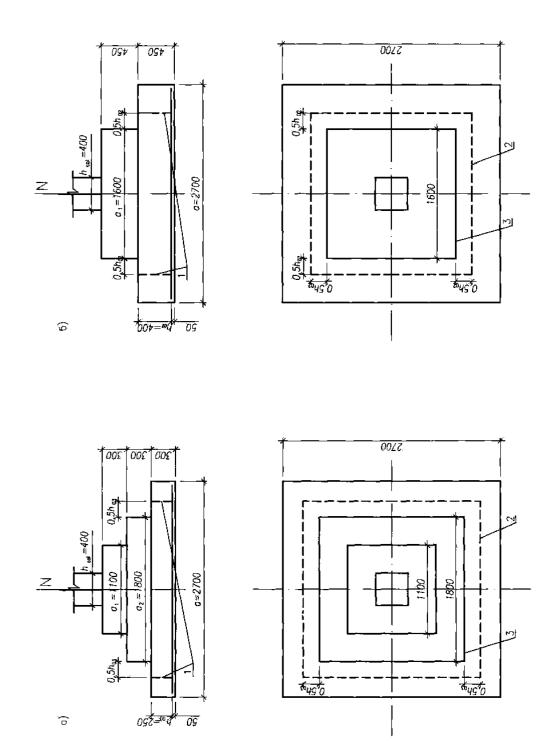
К расчету фундамёнта на продавливание 1-расчетное поперечное сечение; 2-контур поперечного сечения; 3-контур площадки приложения нагрузки.
